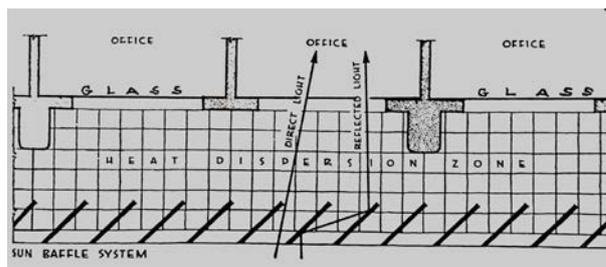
| Detalhe da planta baixa da Associação Brasileira de Imprensa (ABI). Fonte: ABI Building. In *Architectural Record*, jan. 1943, p.49
